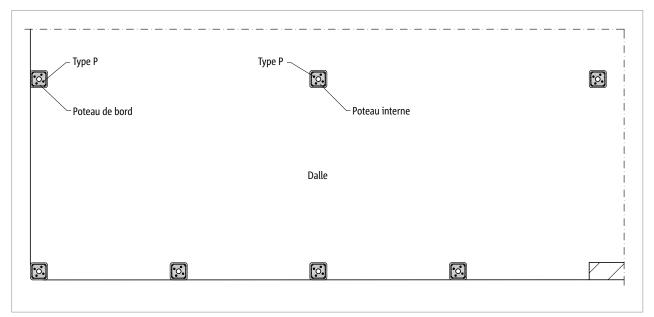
Schöck Sconnex® type P : disposition des éléments en plan
